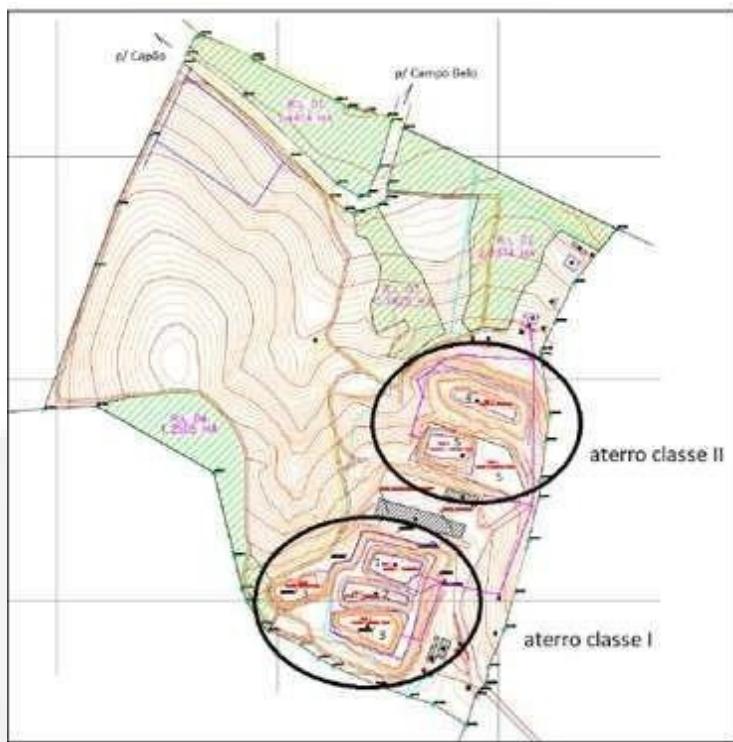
Planta planialtimétrica do empreendimento. Fonte:
